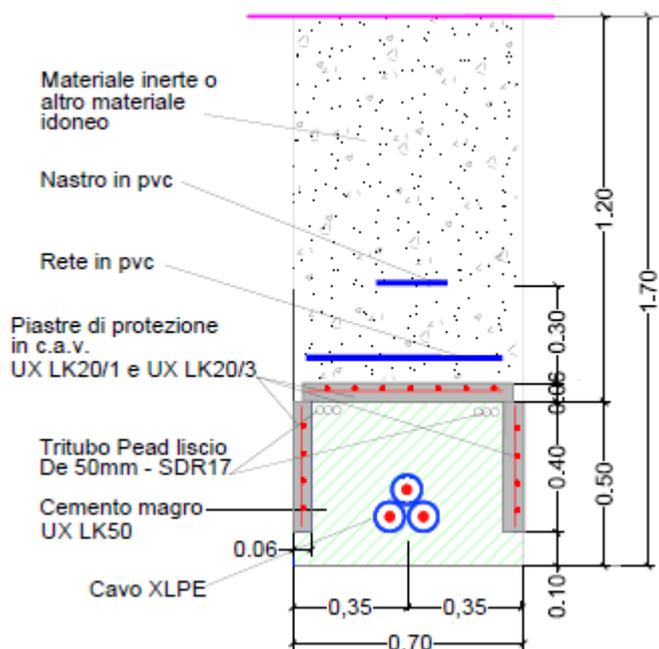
Tipico sezione della trincea per posa cavo AT 150kV-posa su terreno
